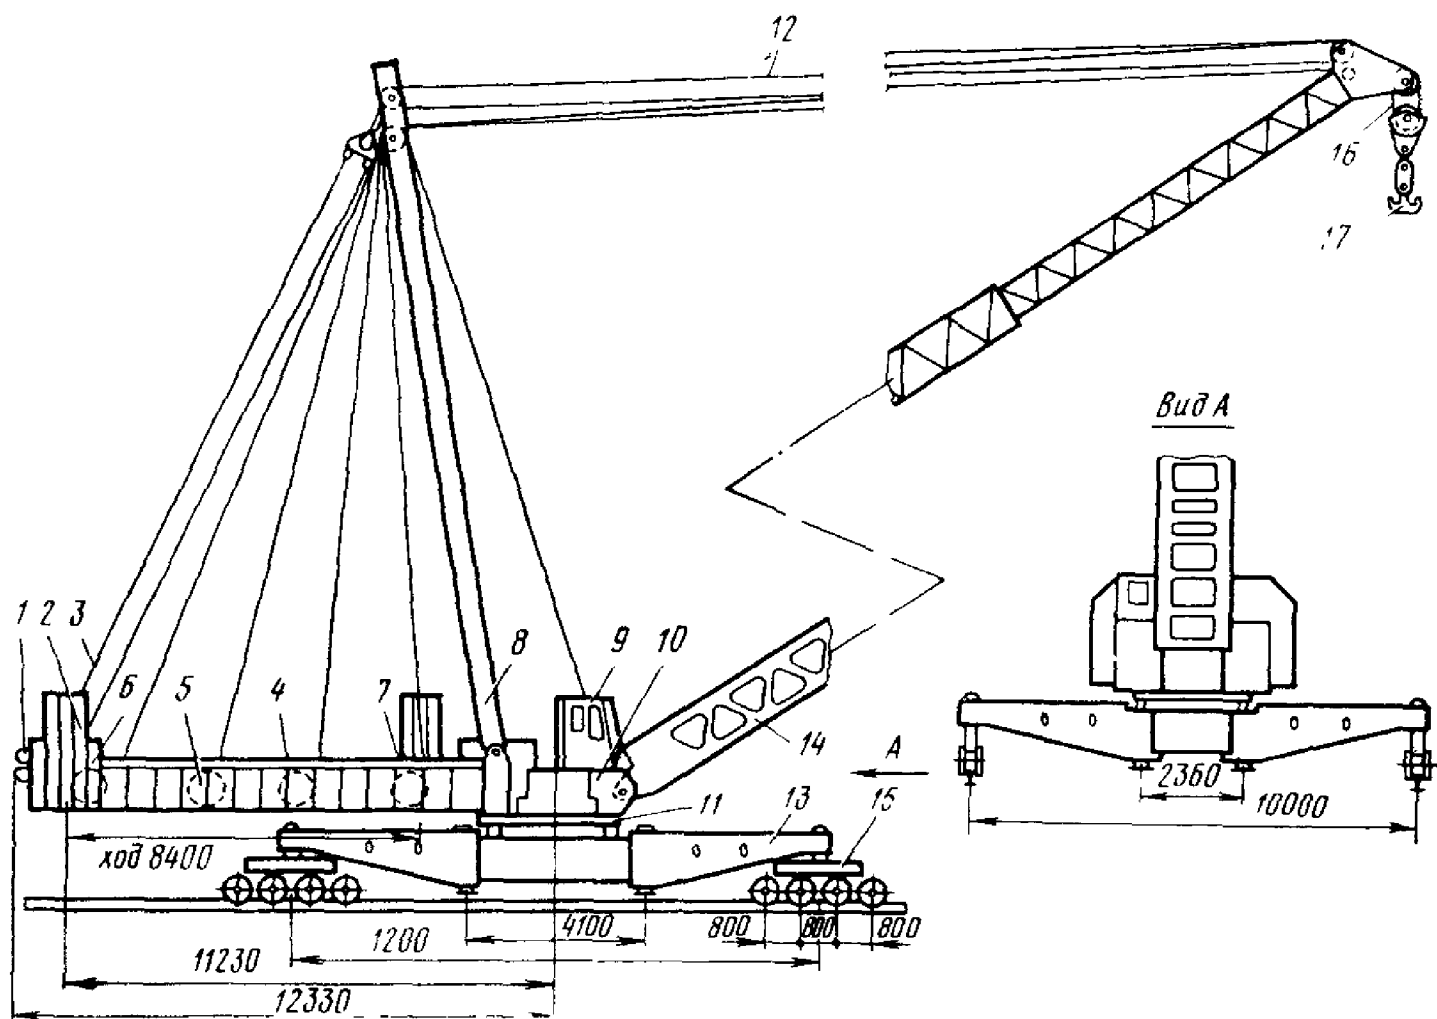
Монтажный кран МК-63 (вариант сборки крана при работе «снизу»):
